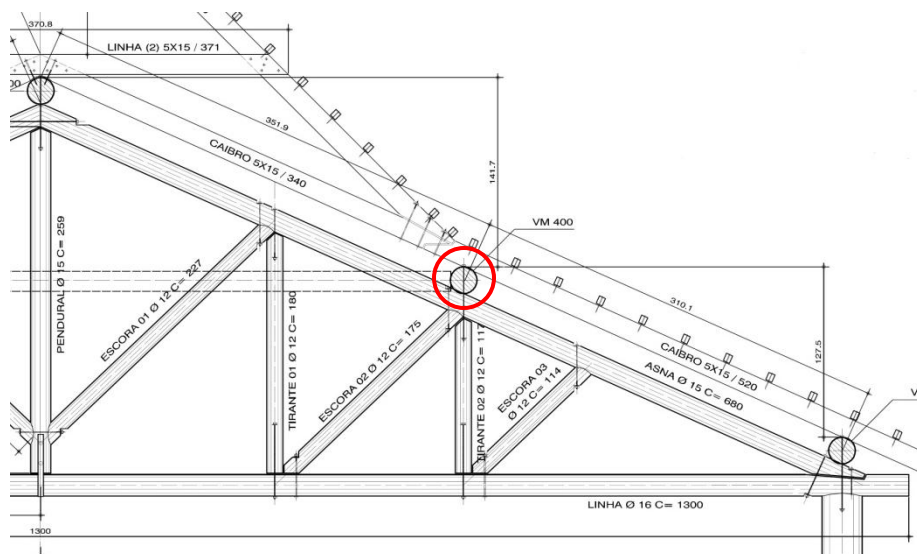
Detalhe terça analisada – Projeto existente de estrutura de madeira
